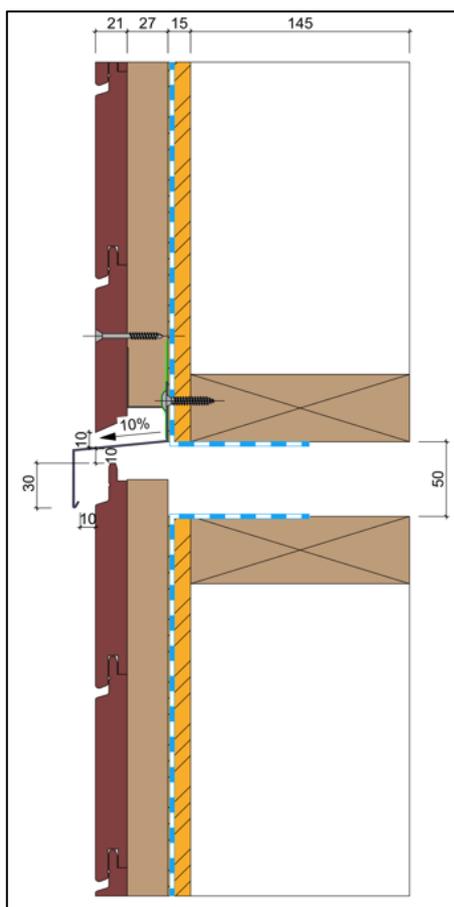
Coupe verticale maquette croix de jonction – bardage bois
